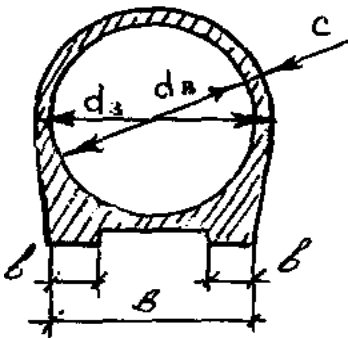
Поперечний переріз бетонної труби з плоскою підшвою
